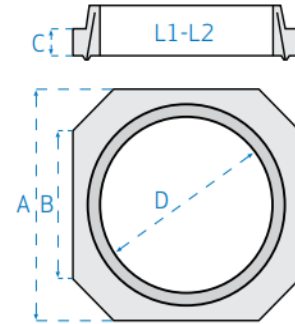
Cono prefabricado de hormigón armado. Fuente: Prefraga
